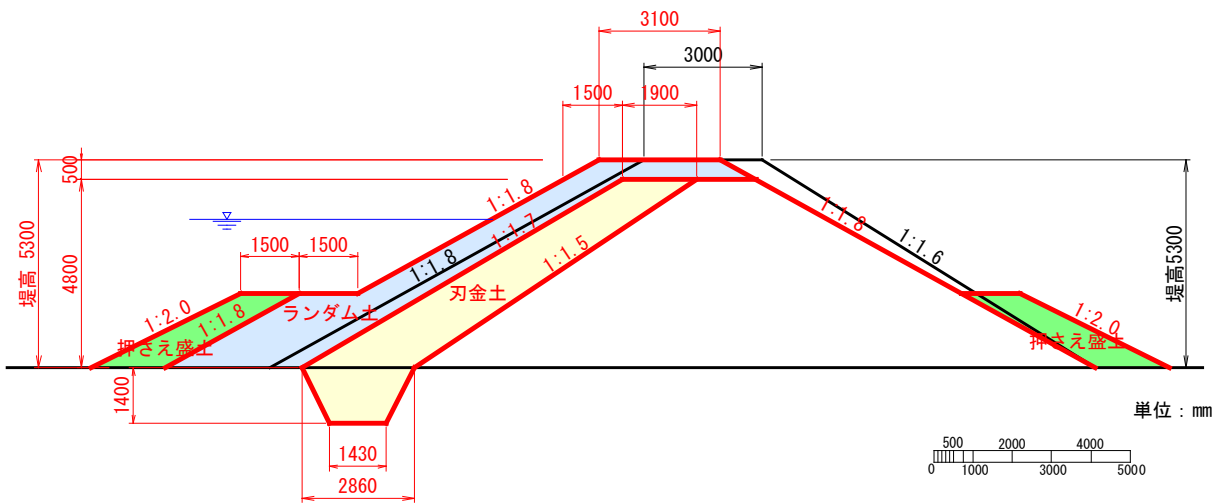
施工コスト算定用計画堤体断面（押さえ盛土工法）-1（H=5.3 m）
